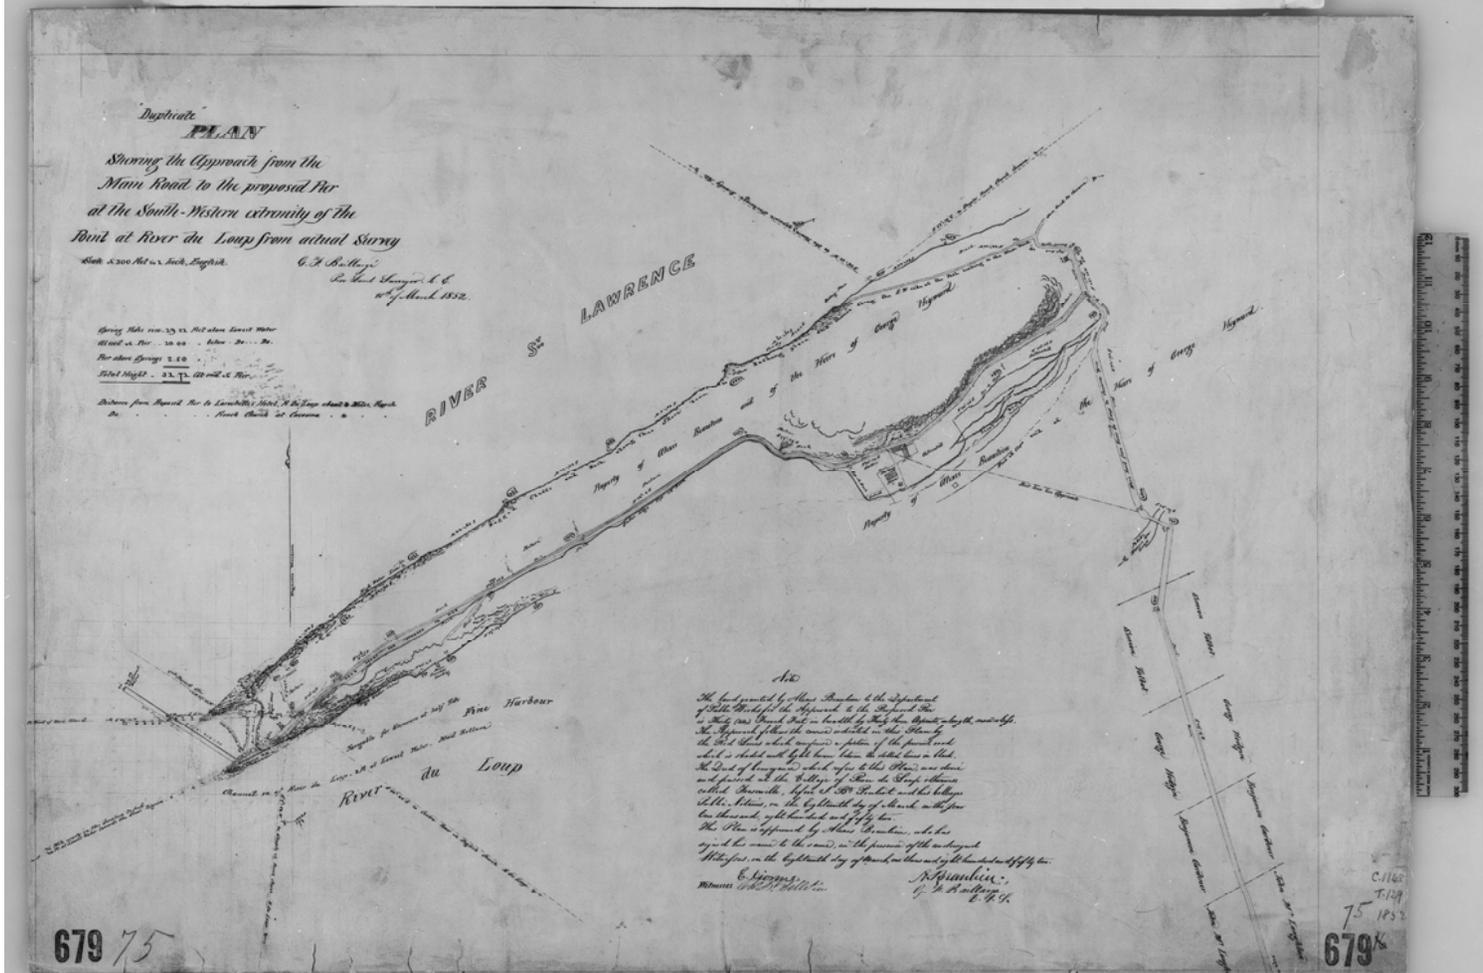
Projet de quai et ses abords à la Pointe de Rivière-du-Loup de 1852.* [Archives nationales du Canada, NMC 20673, « Plan Showing the Approach from the Main Road to the proposed Pier at the South-Western extremity of the Point at River du Loup from actual Survey, C. F. Baillargé, 1852 »]
